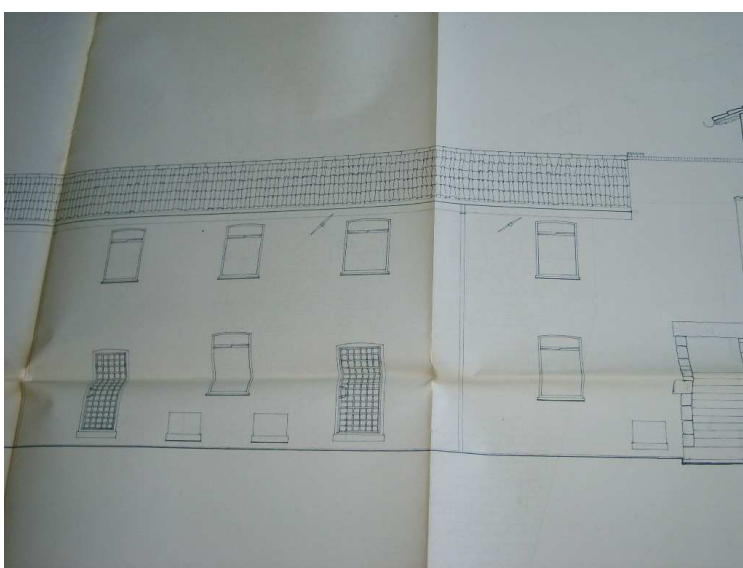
progetto SBAPL -1° cortile corpo nord-prospetto (stralcio)
